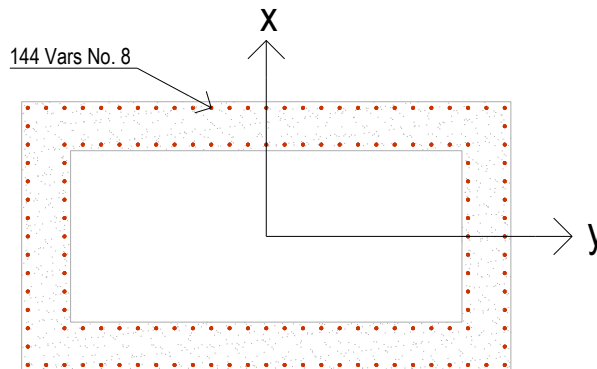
Figura esquemática del armado longitudinal de la pila.
